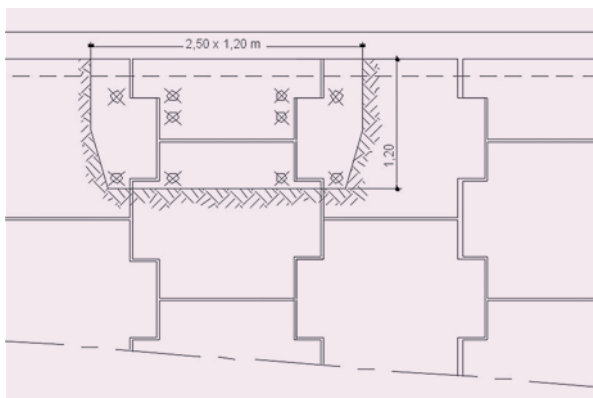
exemple d'implantation (élévation) d'une petite fouille avec repérage des armatures dégagées
